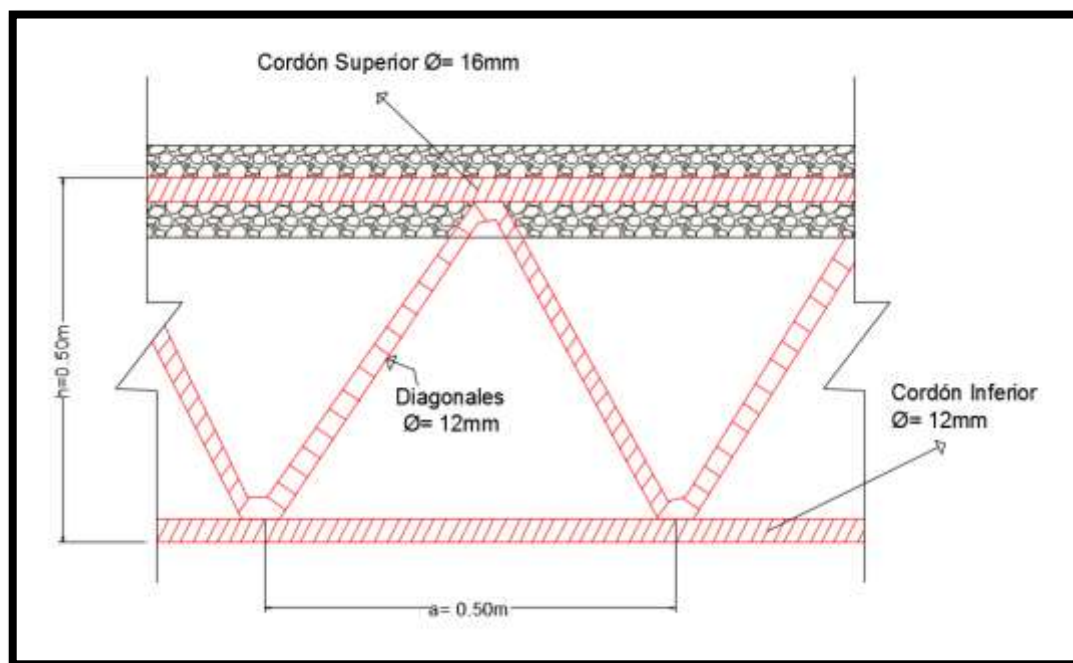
Detalle de una Sección de losa de Entrepiso Circular.
